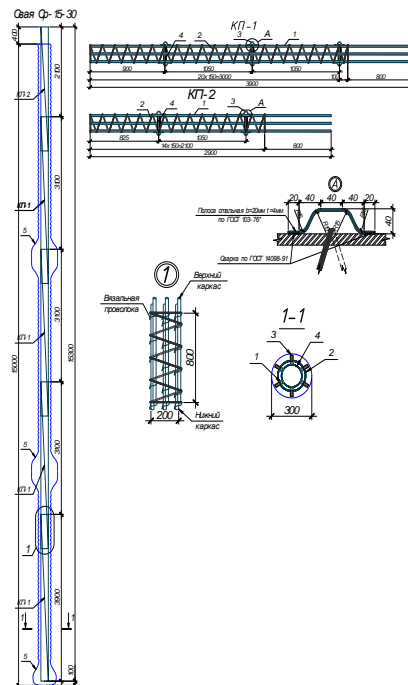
Пример схемы армирования буронагрекционной сваи-ЭРТ Sp-15-30 (15 – длина сваи в м., 30 – диаметр в см.). 1-продольная арматура класса А500с; 2 – поперечная арматура класса А240; 3 – фиксатор каркаса сваи (из стальной пластины b=20мм, t=4мм; 4 - труба d159мм обеспечивает жесткость каркаса при транспортировке и складировании; 5 – уширения вдоль ствола и пята сваи.
